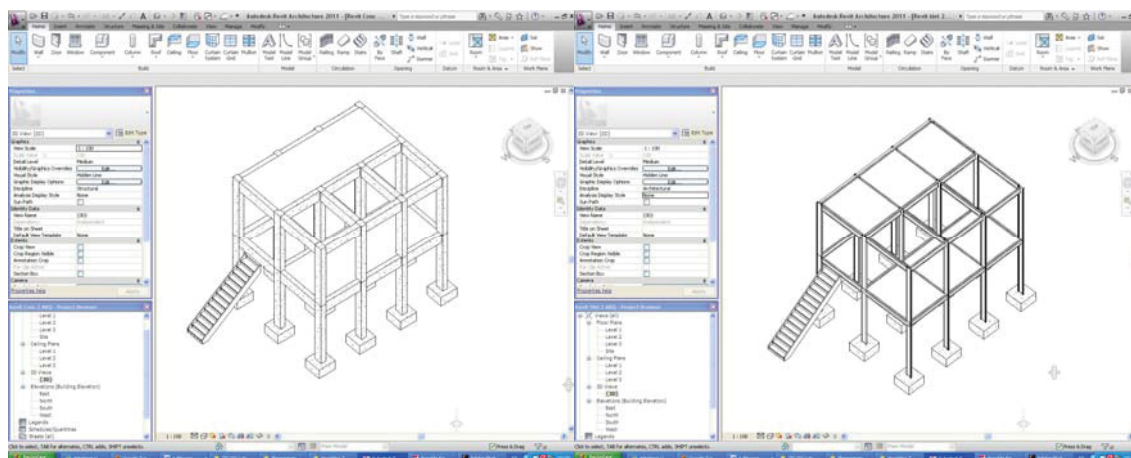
Modelagem estrutural no software Revit Architecture 2011 (concreto e metálica)
